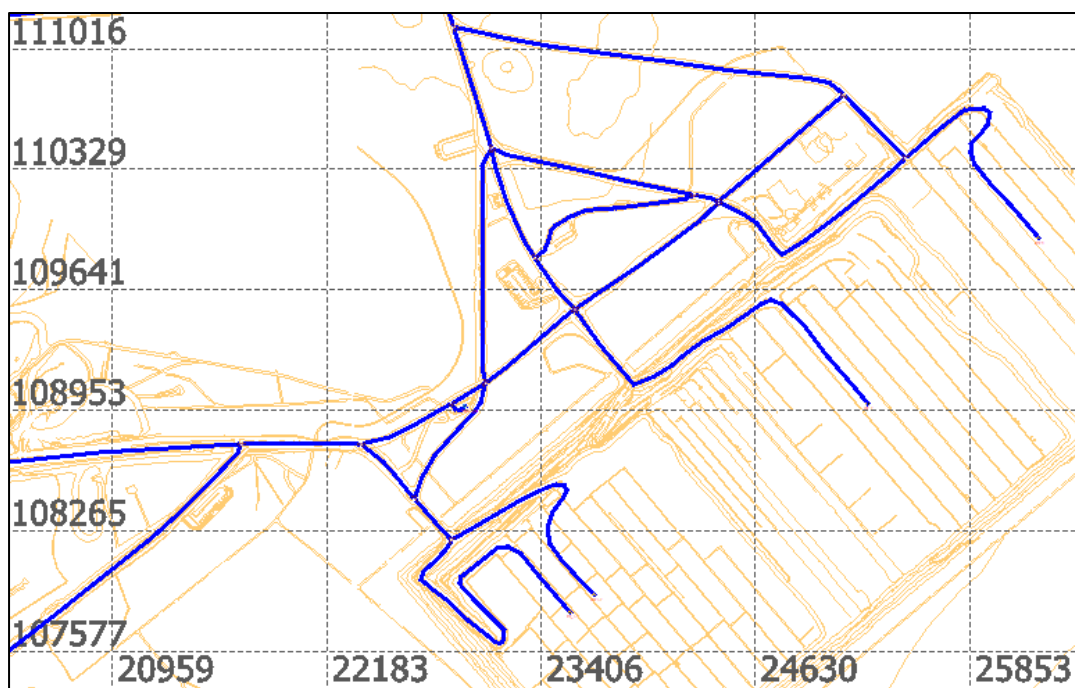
Layout* pilas de lixiviación estáticas de sulfuros de cobre de baja ley según FY 2026. Fuente: Minera Escondida.
